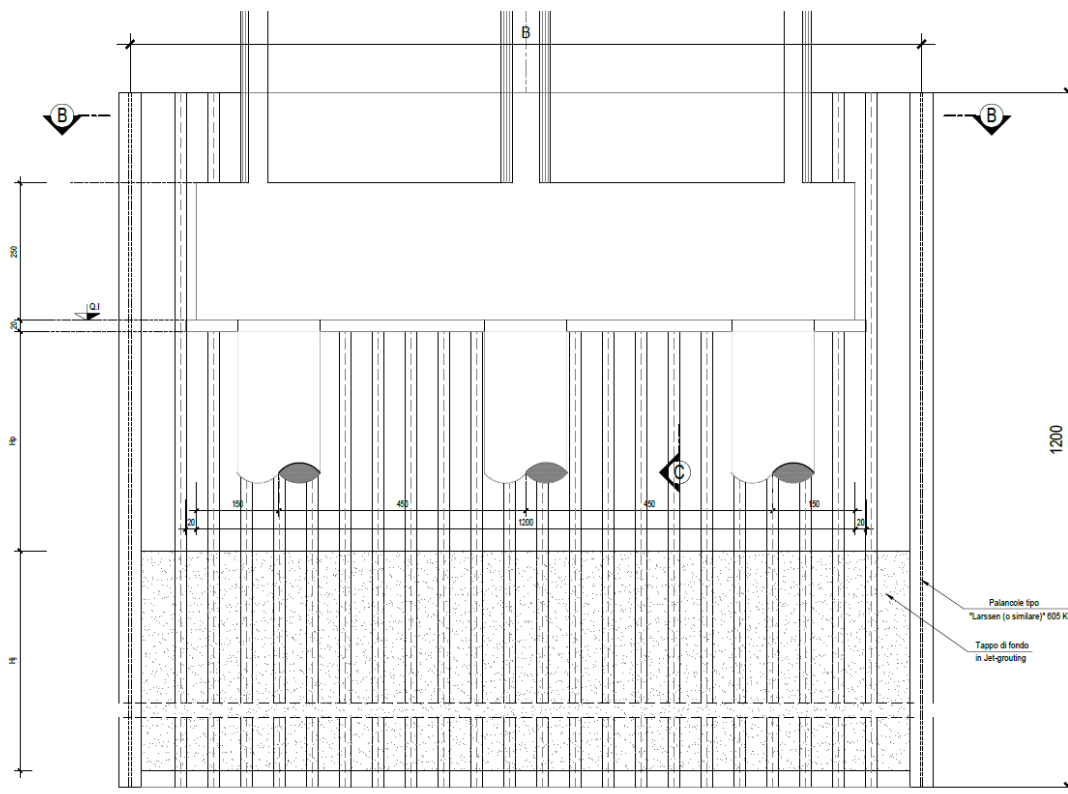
Sezione Tipo Palanca con tampone di Jet Grouting
